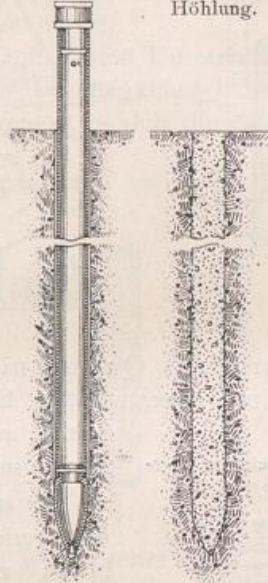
Herstellung eines Beton-Stampfpfahls in weichem Boden.
